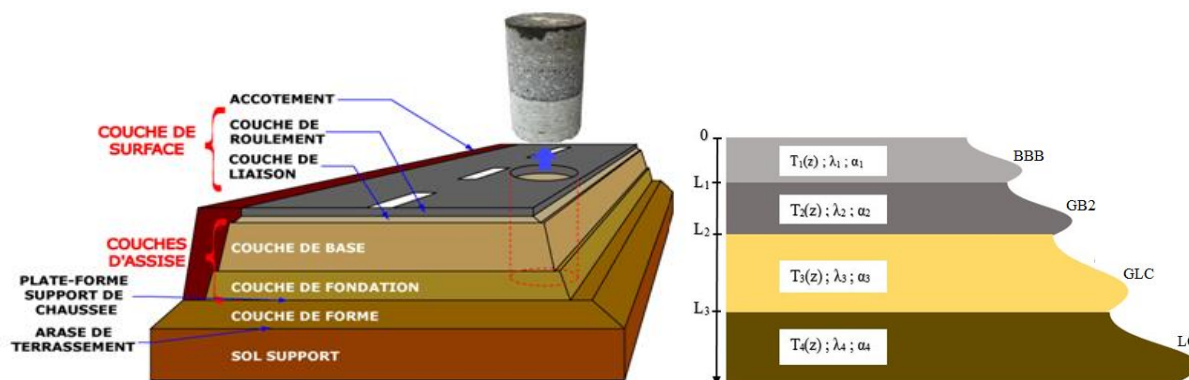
(a) structure d'une chaussée (b) schéma simplifié
